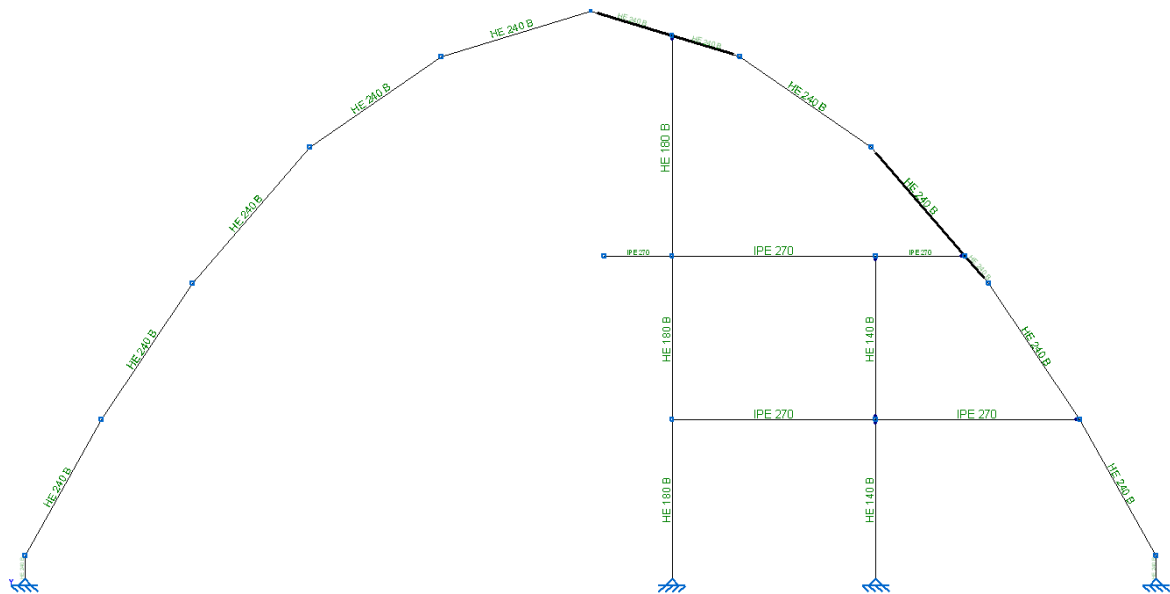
Dimensionado de las barras de los 7 pórticos centrales
